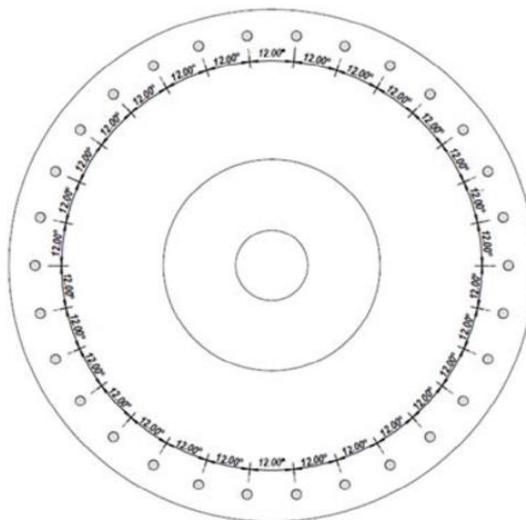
Andamento geometrico della fondazione (pianta – non in scala).
